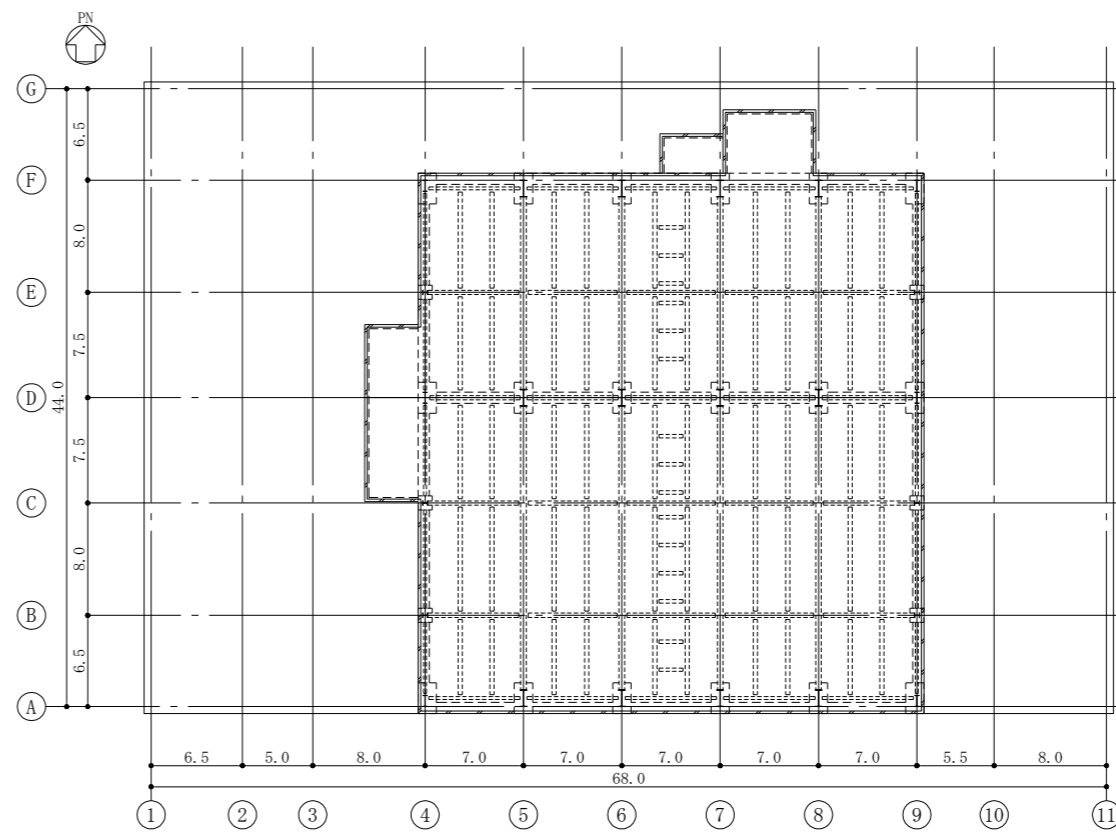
屋根平面図 (その2) (G.L. +25.8) (単位:m)
